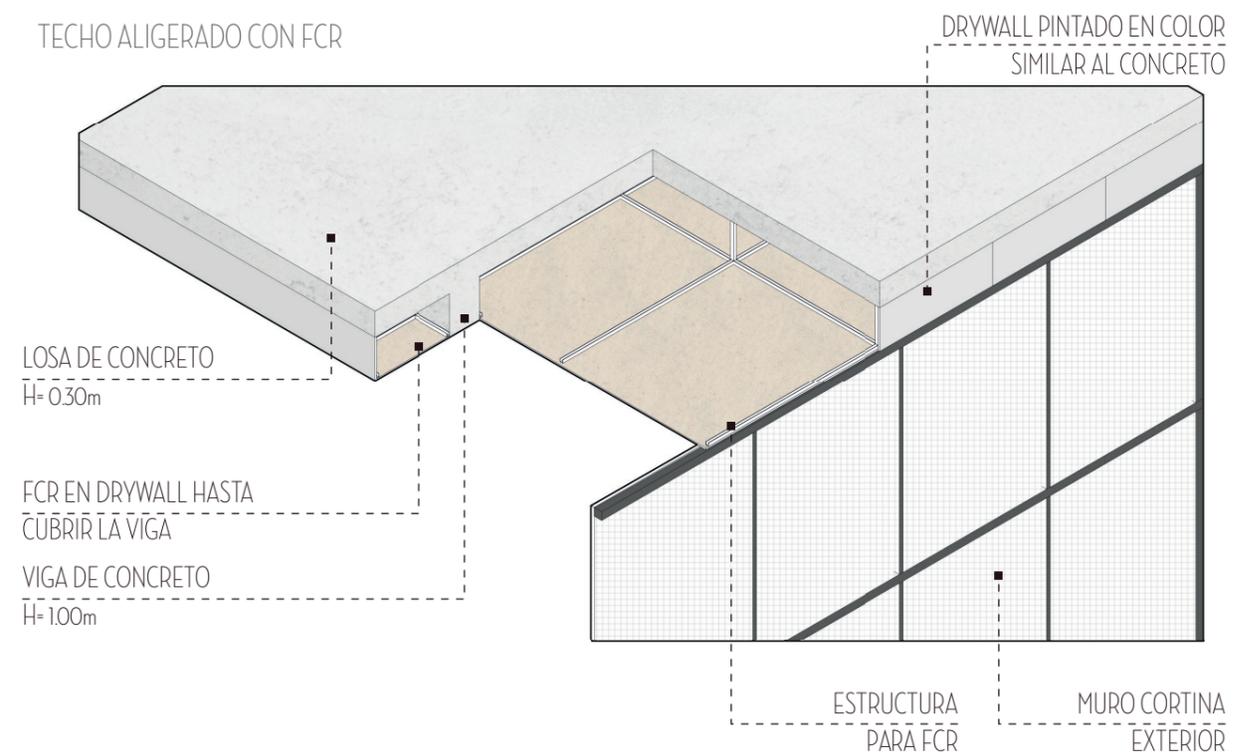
Isometrías del funcionamiento de los elementos estructurales.
